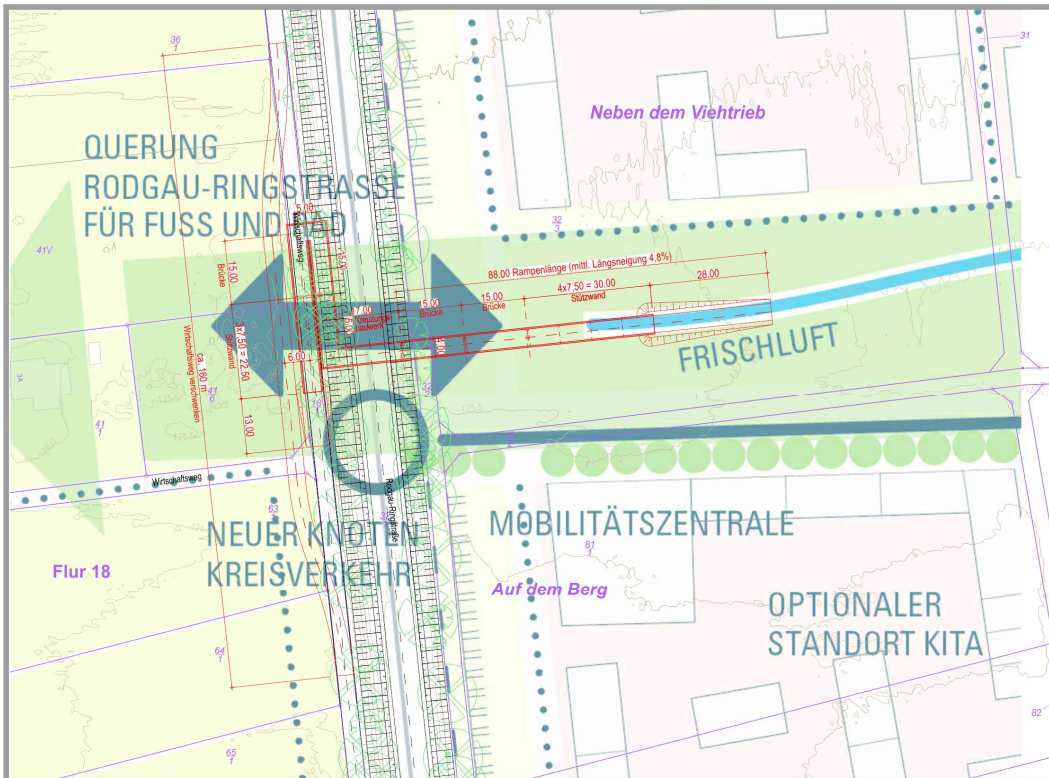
Planungsvariante 1 (Querung als Überführung) – Lageplan.
